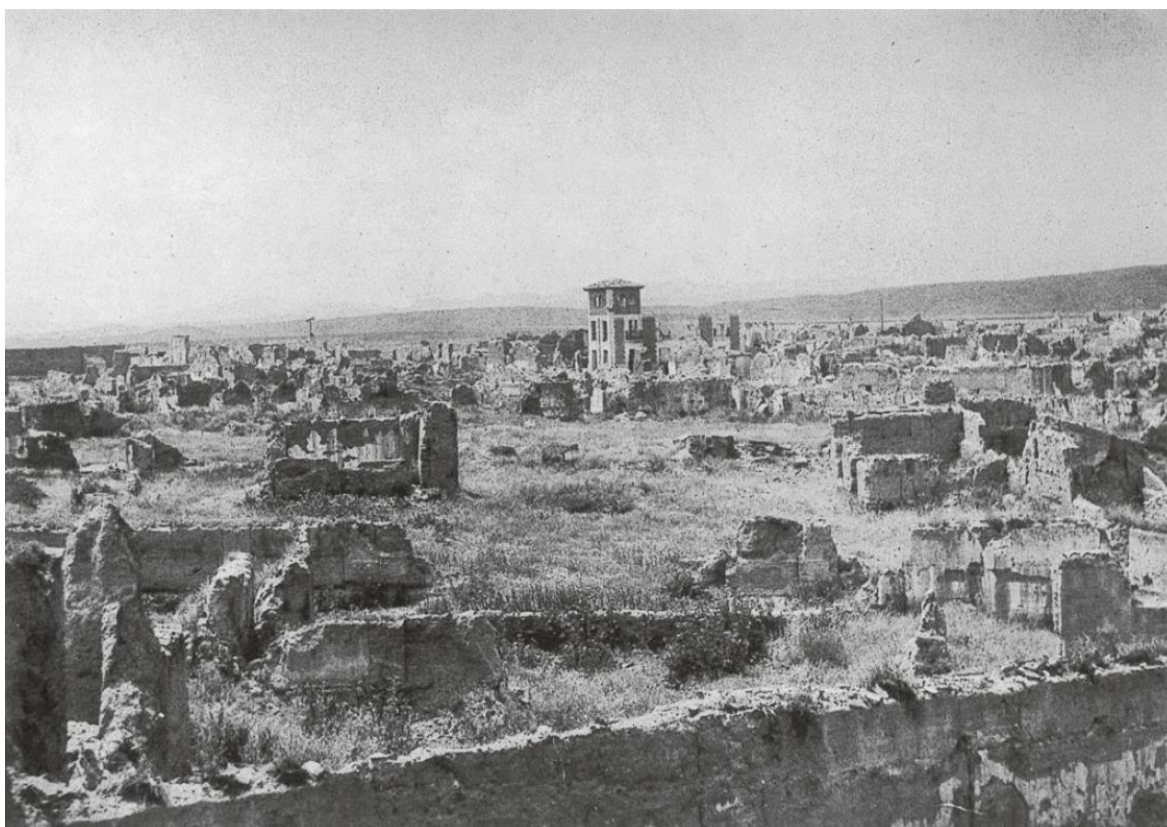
Ruinas de Villanueva de la Cañada después de la contienda. 1939. Fuente: Archivo General de la Administración.
